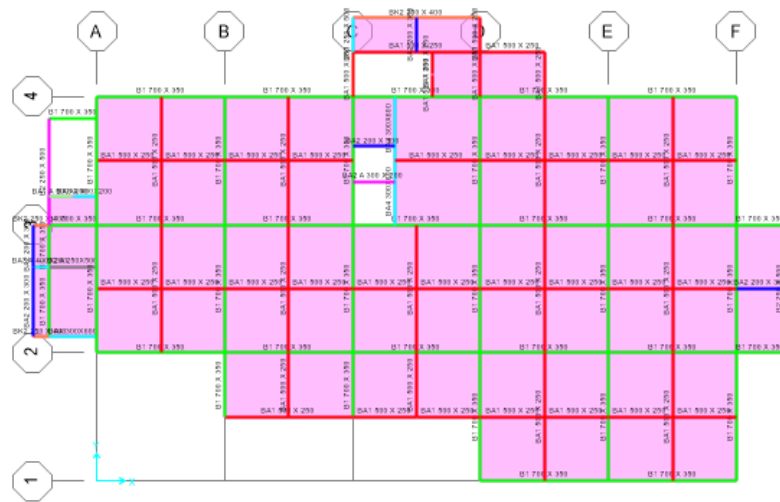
18 Permodelan Balok dan Pelat Lantai 3
